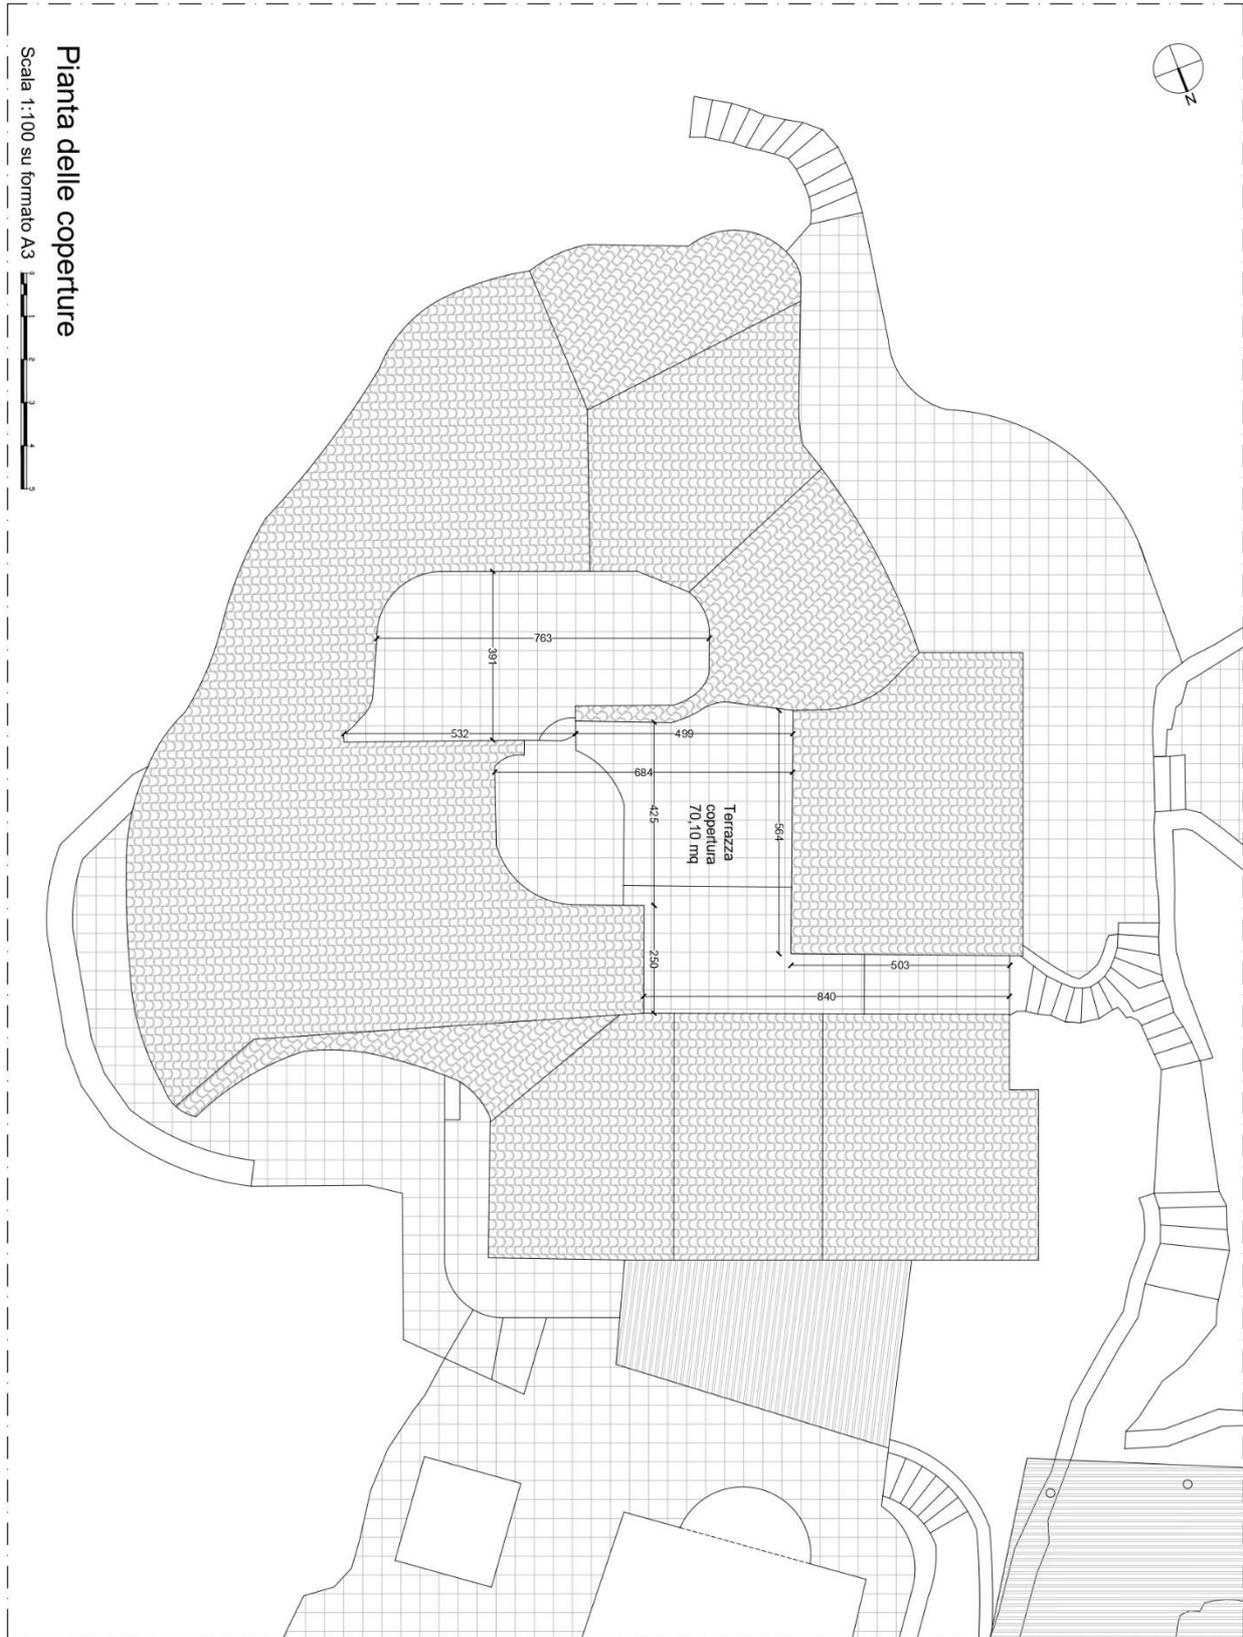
Planimetria dello stato di fatto – pianta delle coperture
